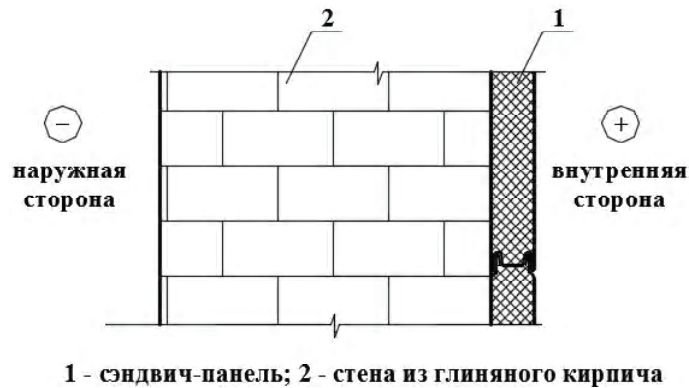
Конструктивная схема наружной стены зданий с внутренним теплоизоляционным слоем.
